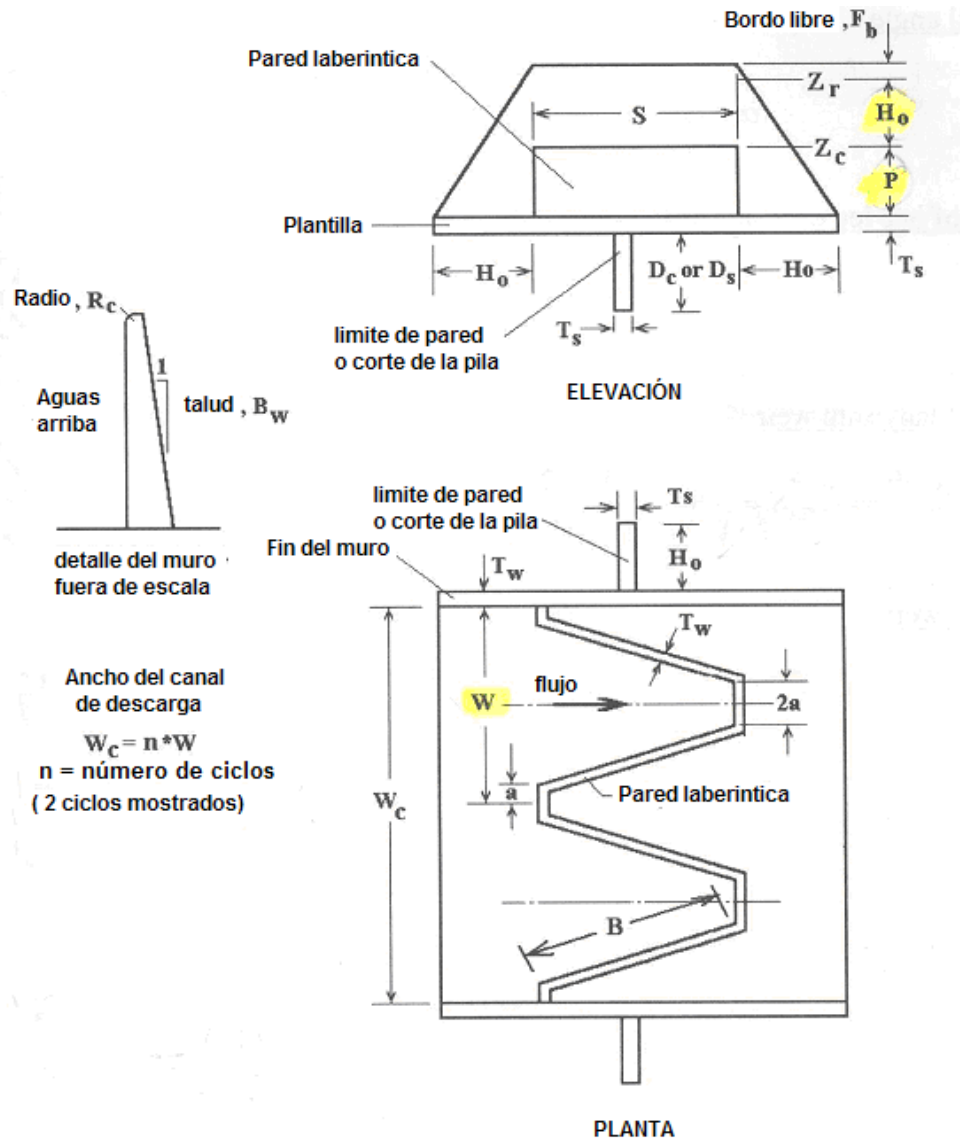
Geometría de vertedor con planta trapezoidal¹²
